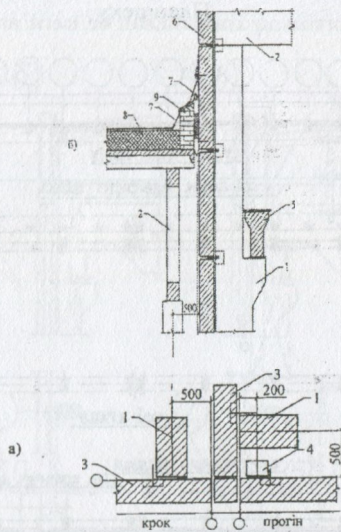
Вузол спряження впритул будівель, показаних на рис. 5.12: а - план; б - переріз: 1 - колона; 2 - кроквяна балка; 3 - панельна стіна; 4 - фахверкова колона; 5 - підкранова балка; 6 - парапетна панель; 7 - фартух; 8 - покриття будівлі; 9 - цегляна стінка.
